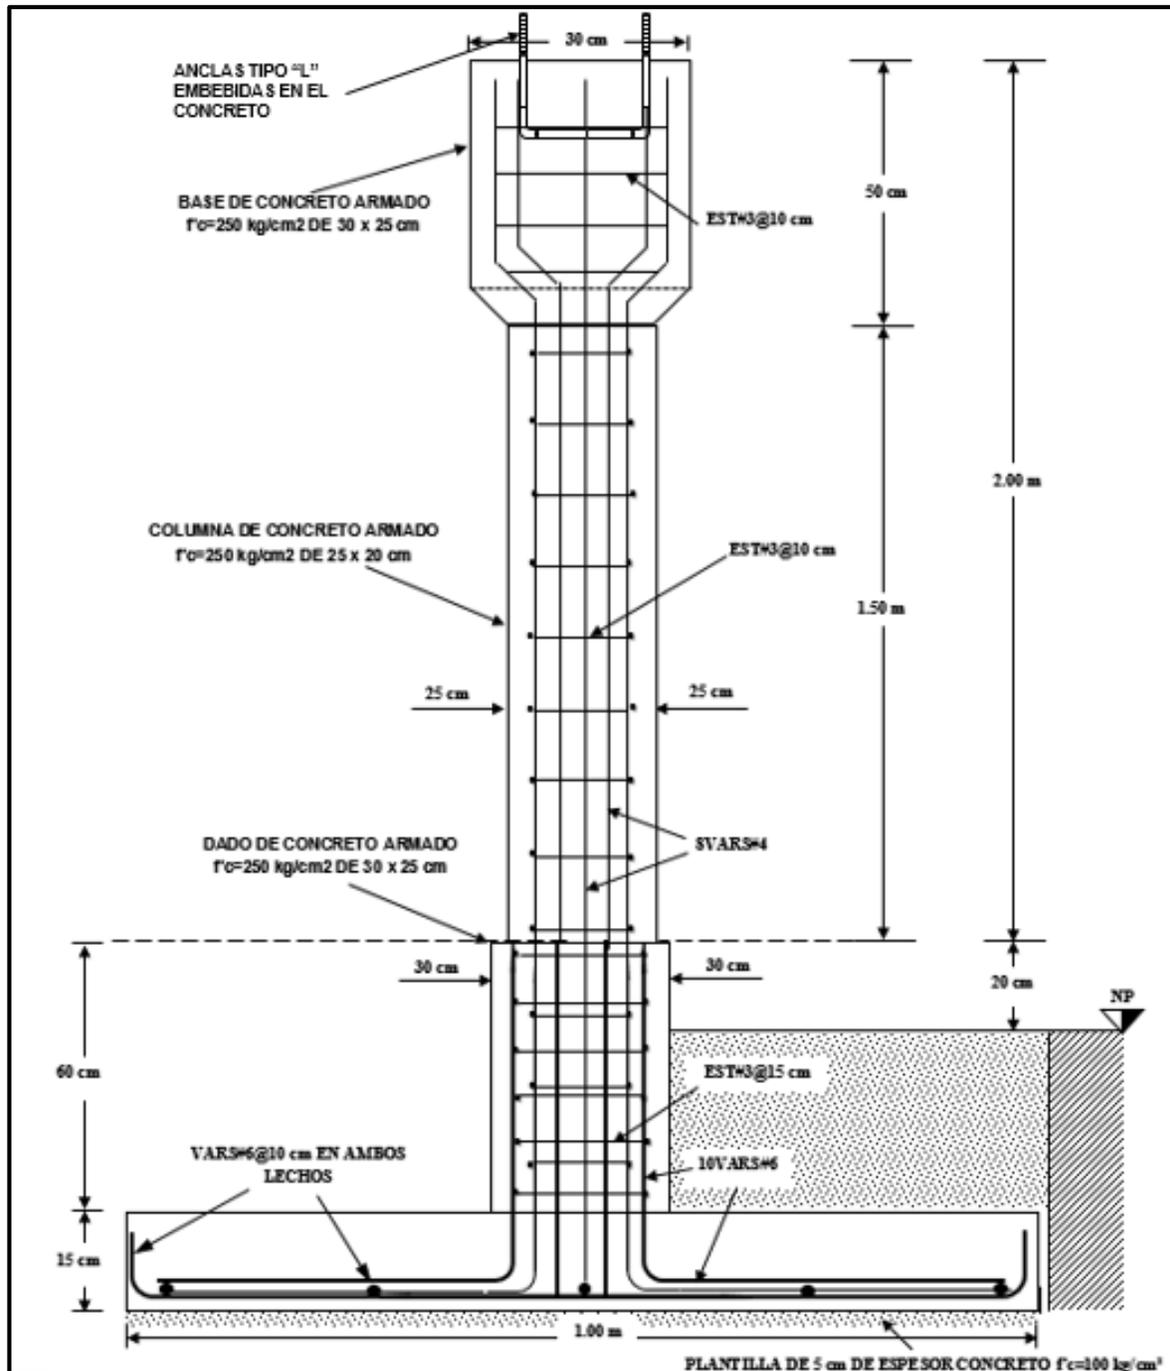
Armado de zapata aislada, dado, columna y base para Equipo Menor
